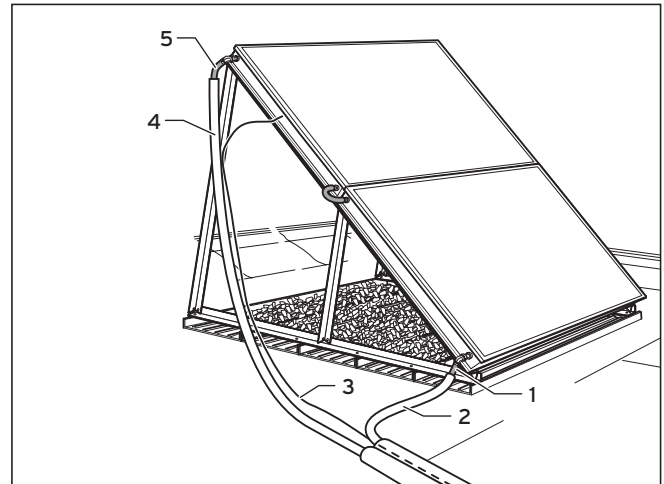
Toegestane standen van het knikstuk aan de bovenste collectoraansluiting bij een buisgeleiding
